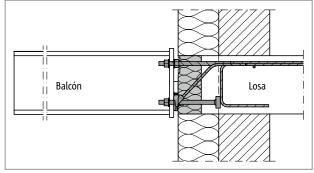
Schöck Isokorb® T tipo SK: Con ayuda del saliente de la losa, el elemento aislante cierra al ras con el aislamiento del muro. Aquí se deberán tener en cuenta las distancias laterales al borde
